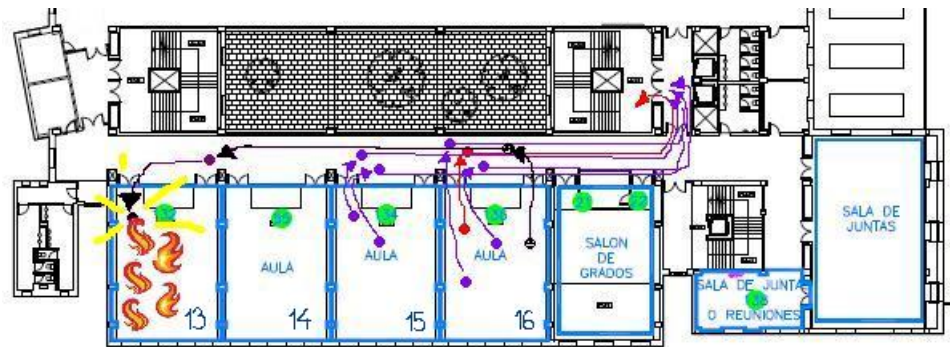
Planta primera de la Facultad de Informática en un ejemplo de evacuación
